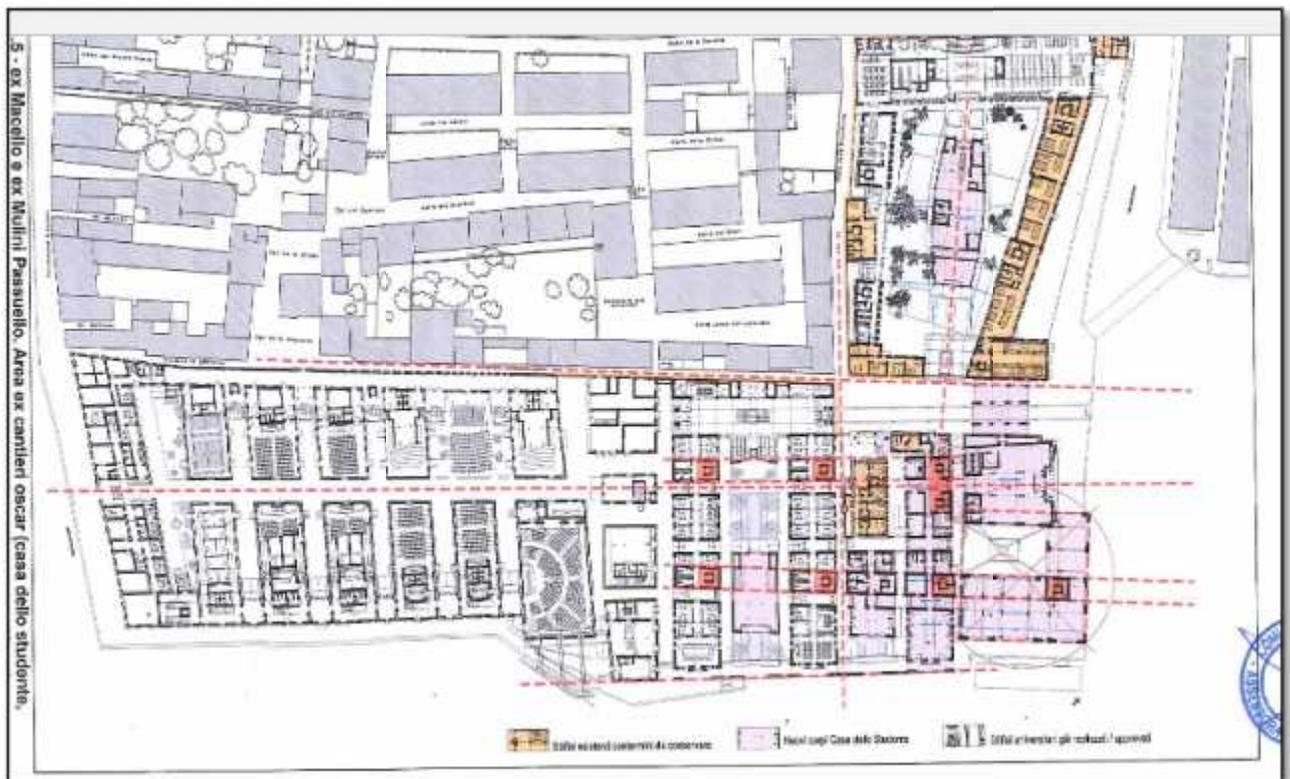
Site de San Giobbe Venise projet du pole universitaire plan definitif du rez de chaussée. . Sr. <http://www.studionavespigai.it>
